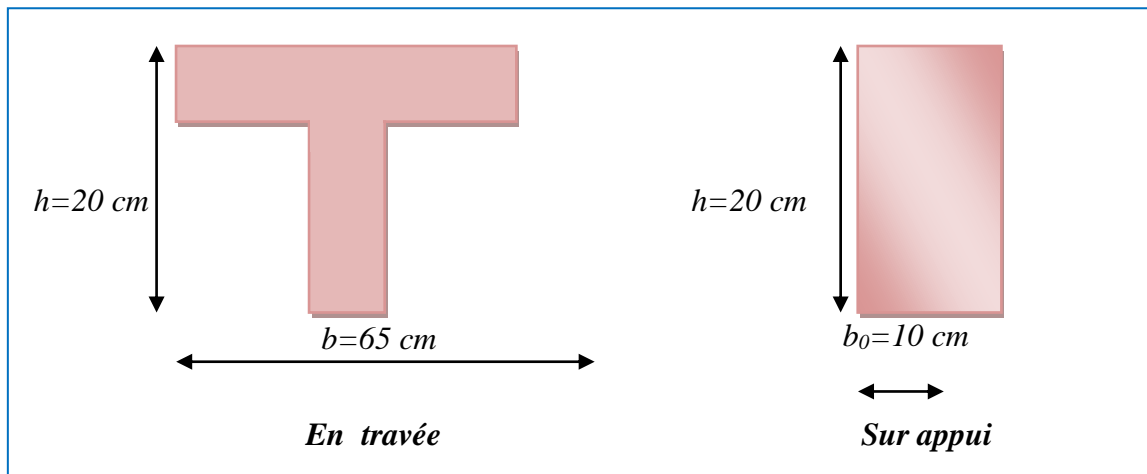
Schéma section rectangulaire en travée et sur appuis
